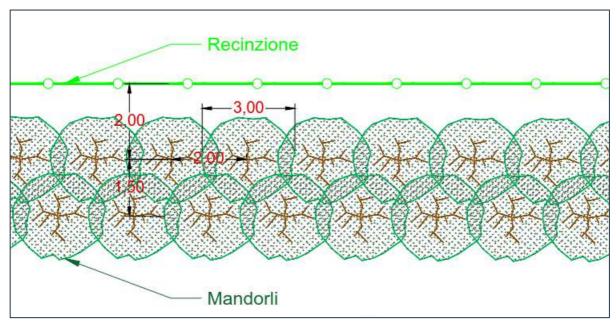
Sesto d'impianto della fascia perimetrale con larghezza 5 m
